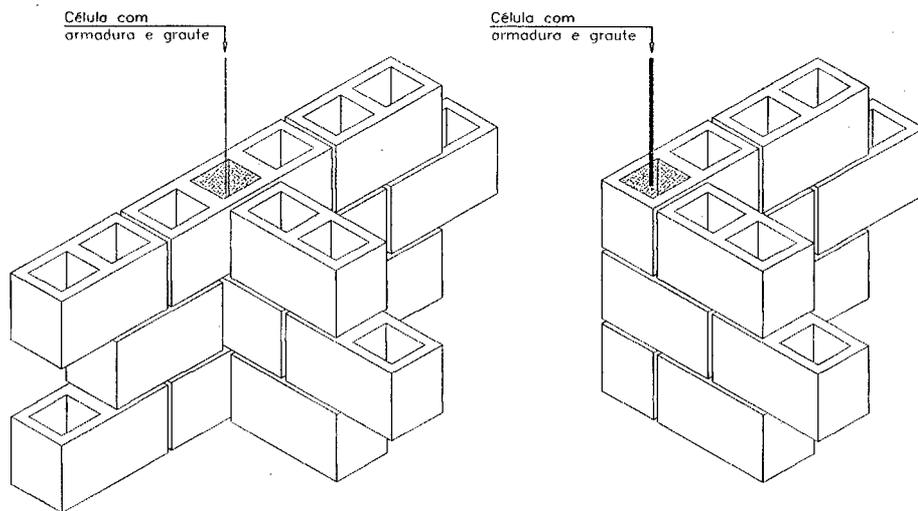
Detalhe de amarração de paredes estruturais – modulação de 30cm
